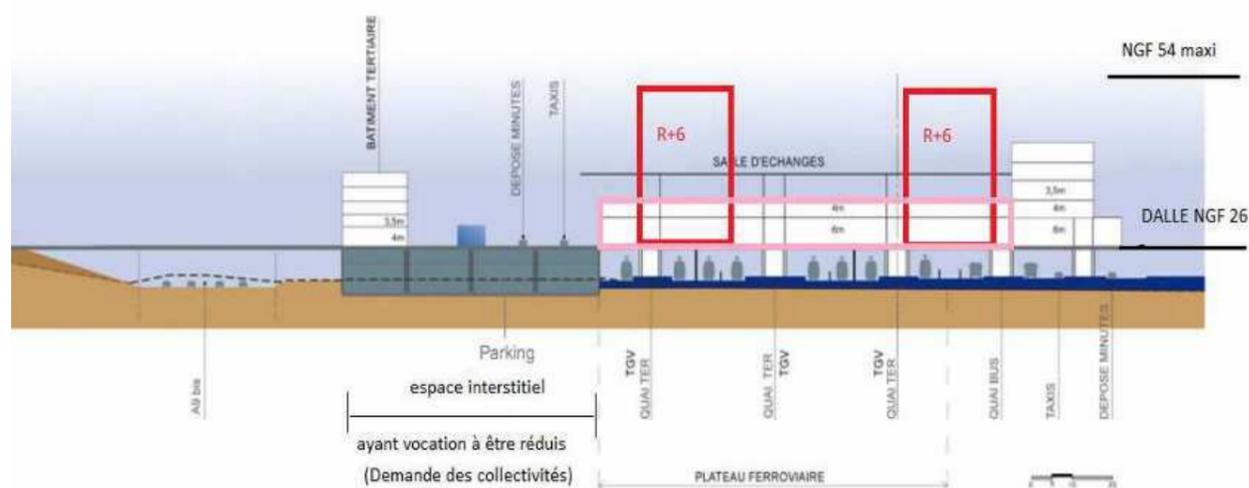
Vue en coupe de la gare nouvelle de Montpellier
